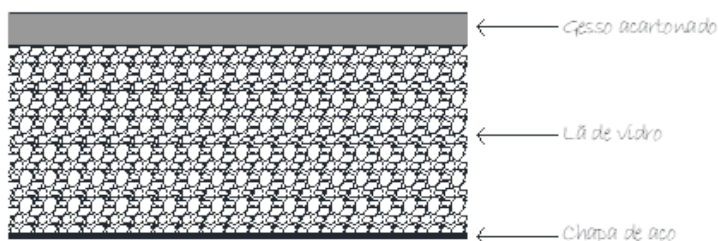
Detalhe esquemático em planta da vedação vertical externa e cobertura do módulo habitacional padrão em container.
